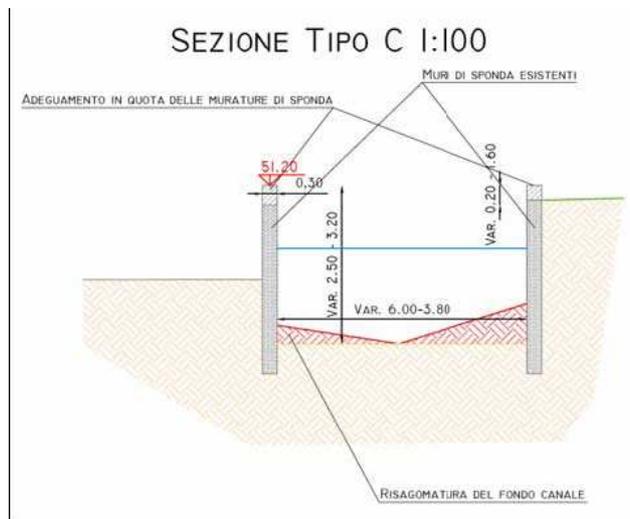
Sezione tipologica di intervento a valle dell'attraversamento al vialetto di accesso privato.
